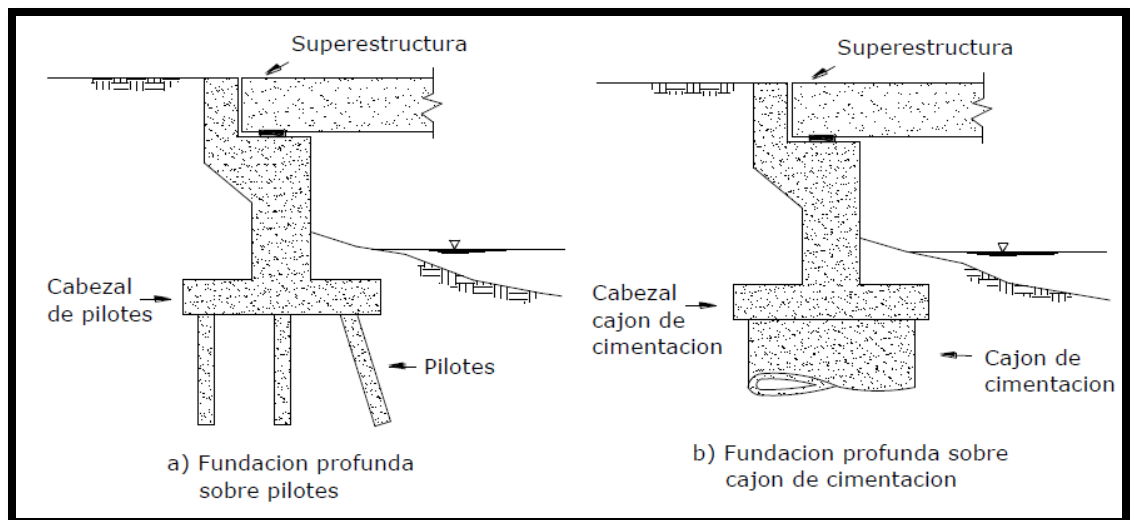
Fundación profunda sobre a) pilotes, b) cajón de cimentación
